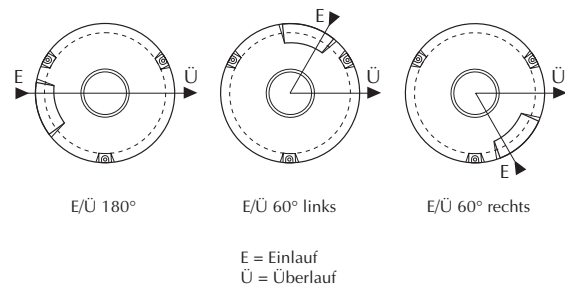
Möglichkeiten der Konusverschraubung (Draufsicht)
